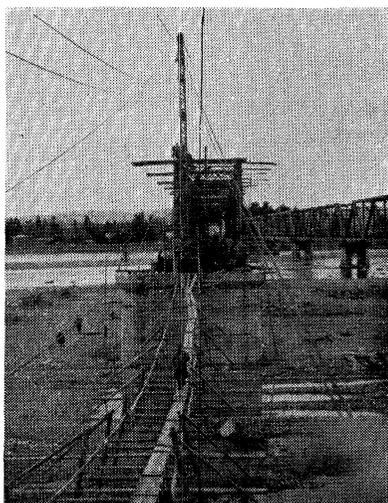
下流側トラスを固定し上流側へ拡幅量 2.65 m 横移動完了
